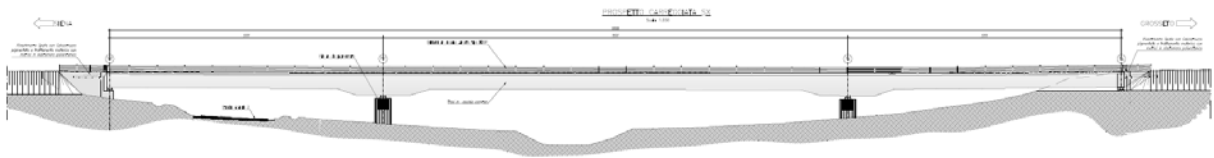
Prospetto Viadotto sul fiume Orate
